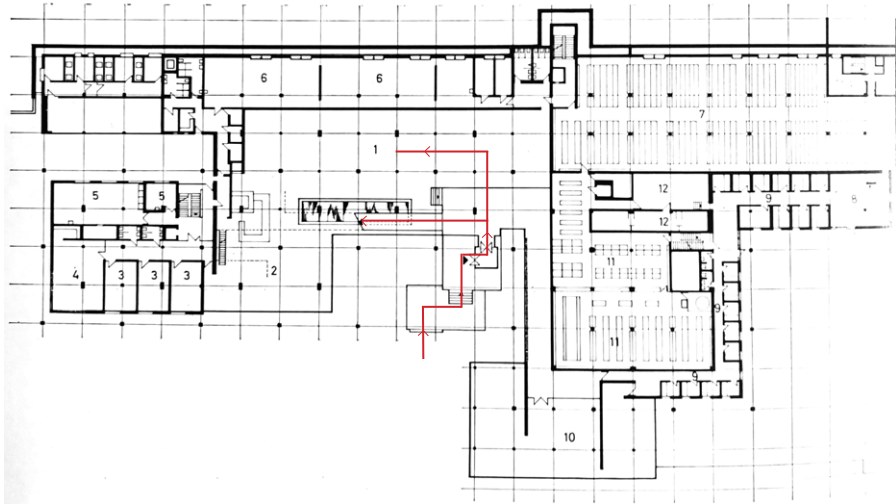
Planta primera, acceso desde Urbanstrasse.
